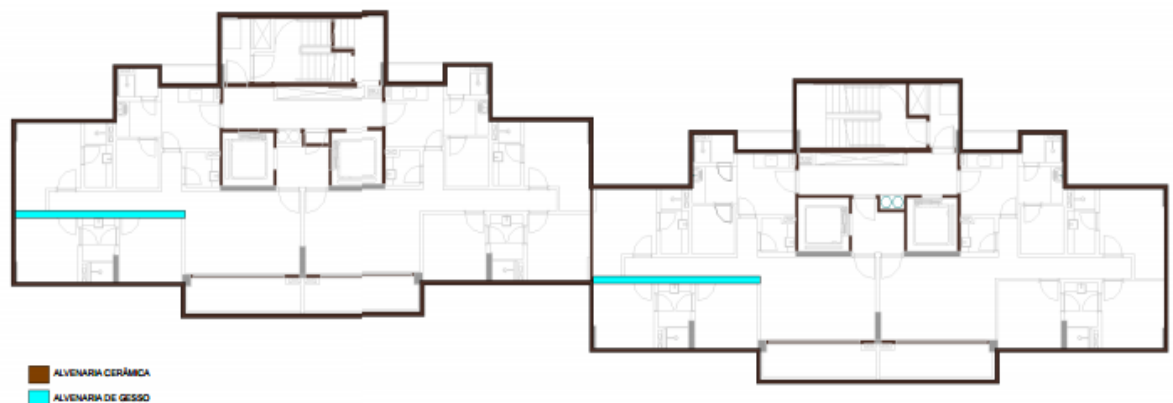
Planta baixa do projeto de alvenaria em bloco de gesso.
